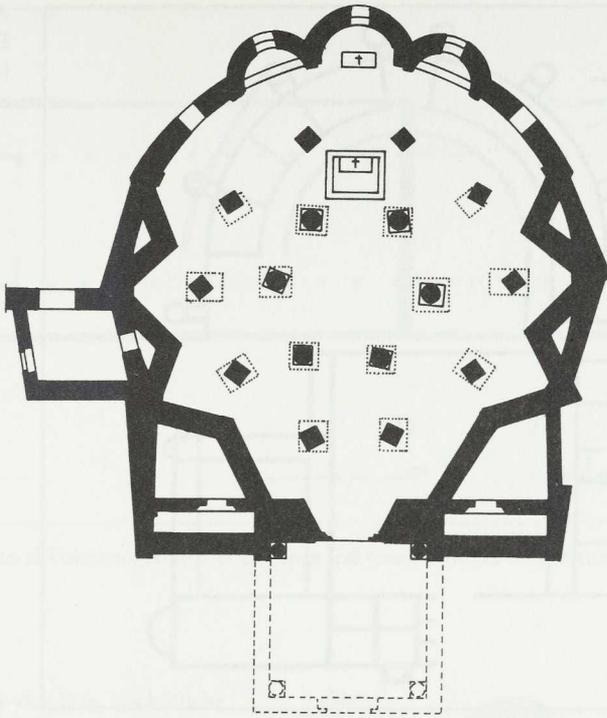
Benevent, S. Sofia, Grundriß (nach Rotili)
